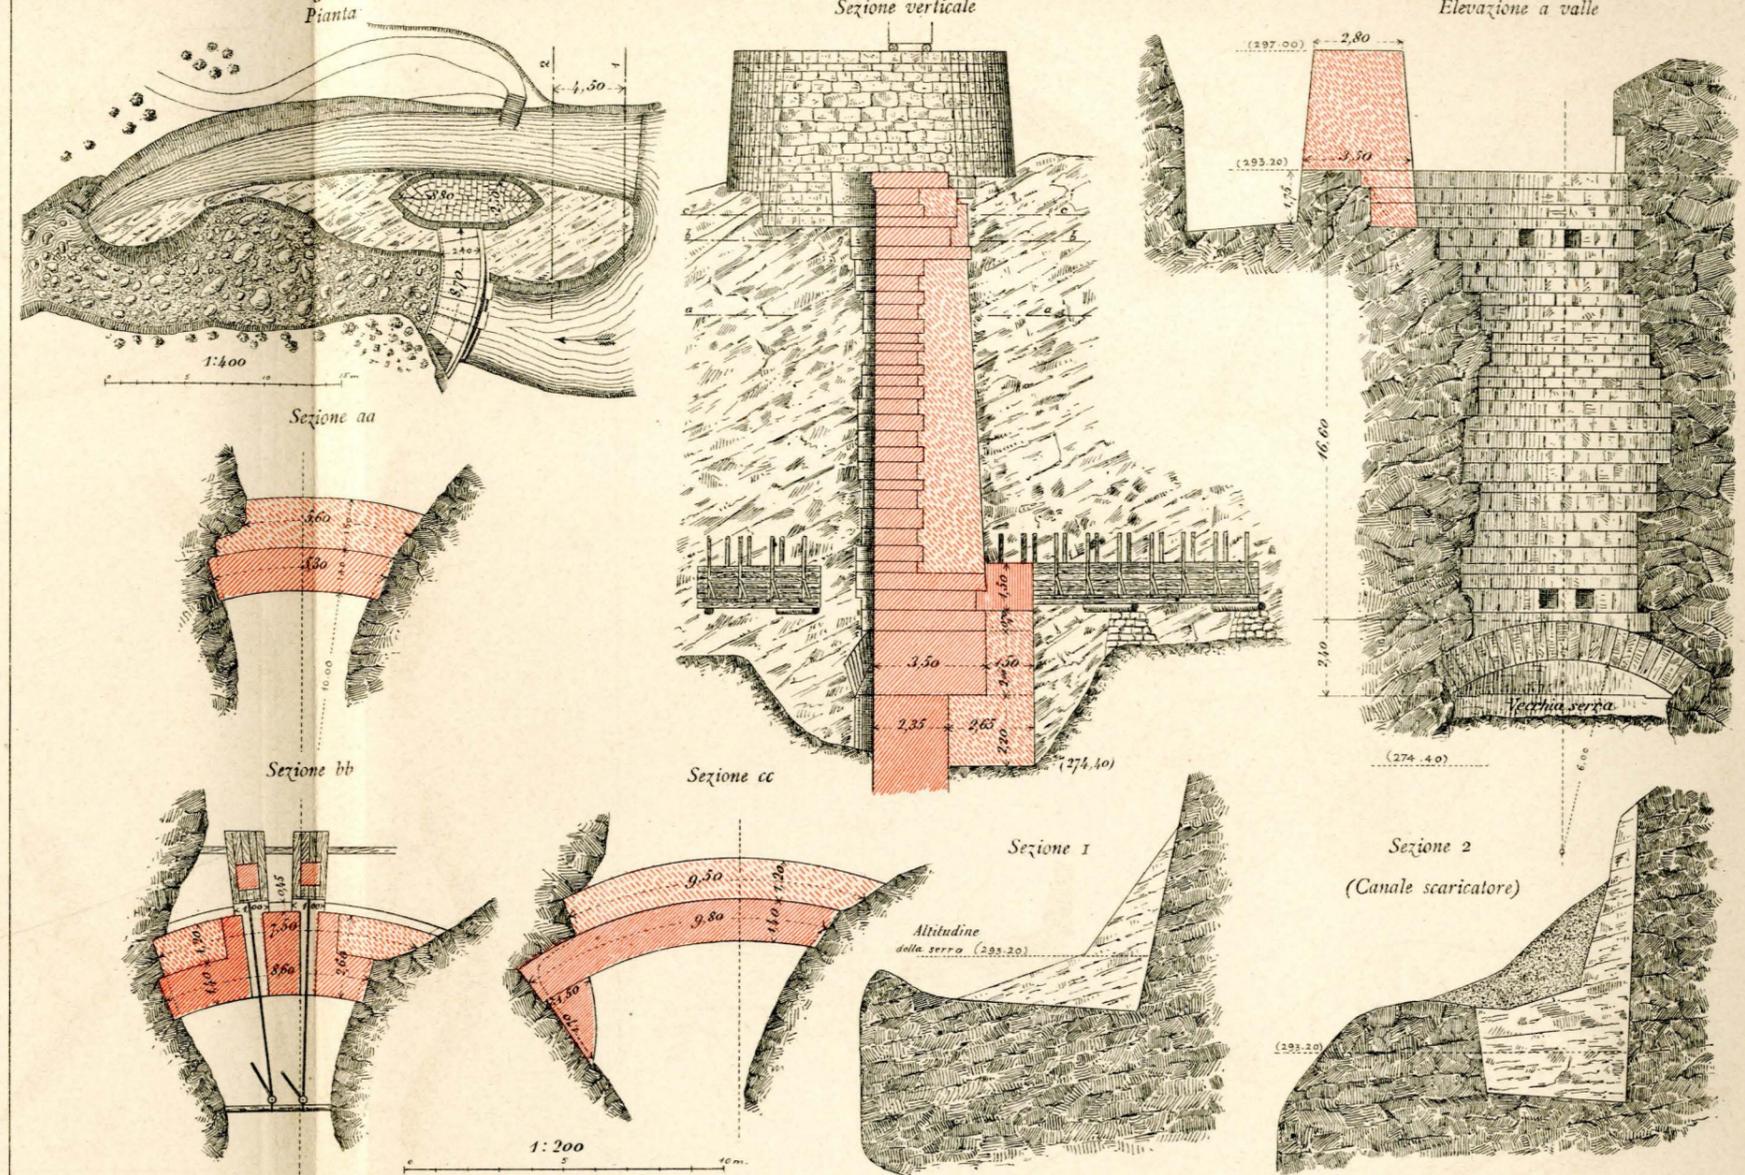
a 18. — Serra di S. Colombano. - Planimetria, sezione verticale e canali deviatori.
